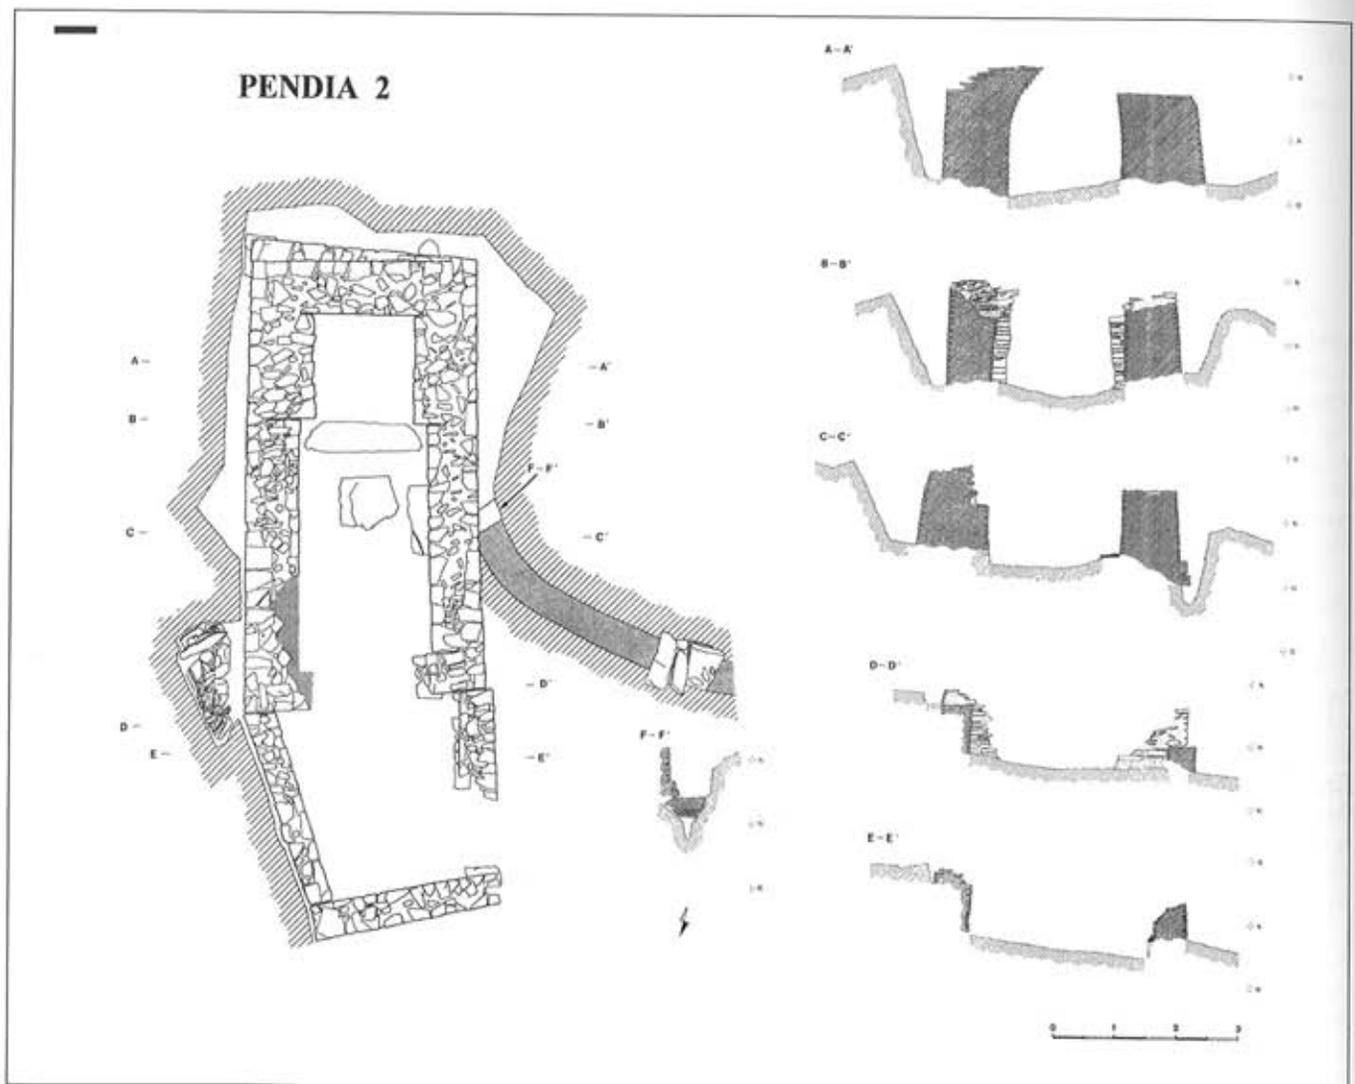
Pendia 2. Planta y secciones del edificio y canal de drenaje.
